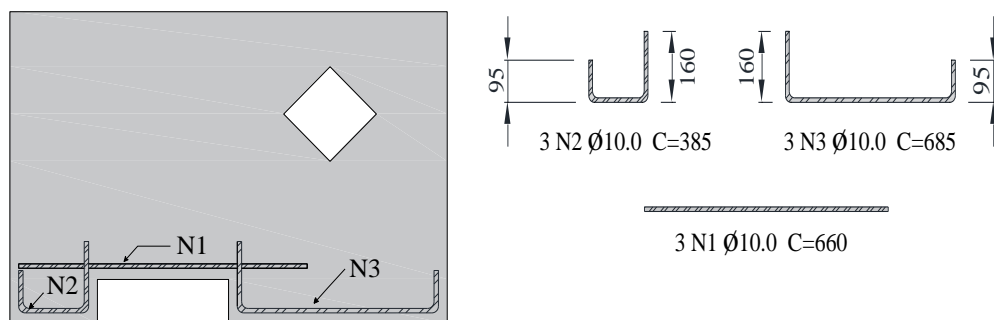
Detalhamento das armaduras de DB1-H1-U e DB3-H1-S-FS (dimensões mm)
